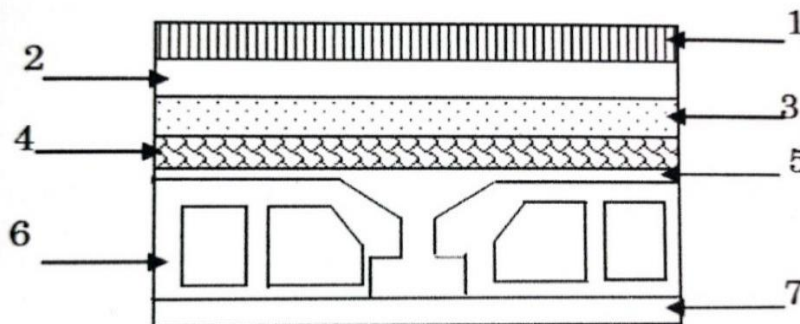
coupe de plancher terrasse inaccessible en corps creux
